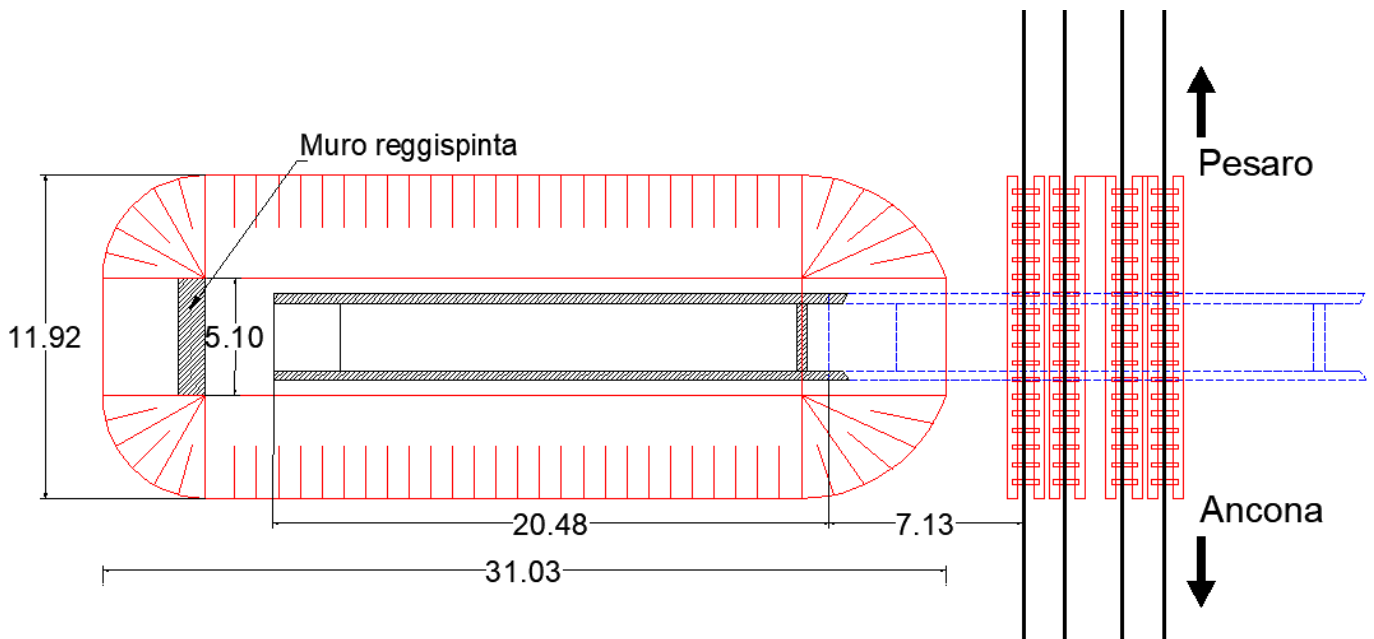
Schema scavo di cantiere e area d'ingombro dei lavori.
